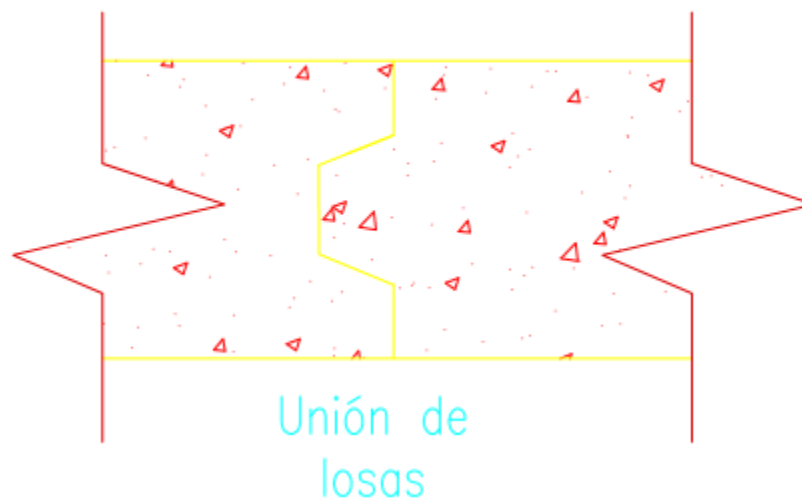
Esquema de unión entre la losa de hormigón de la Carretera Central con la losa de la solución propuesta
